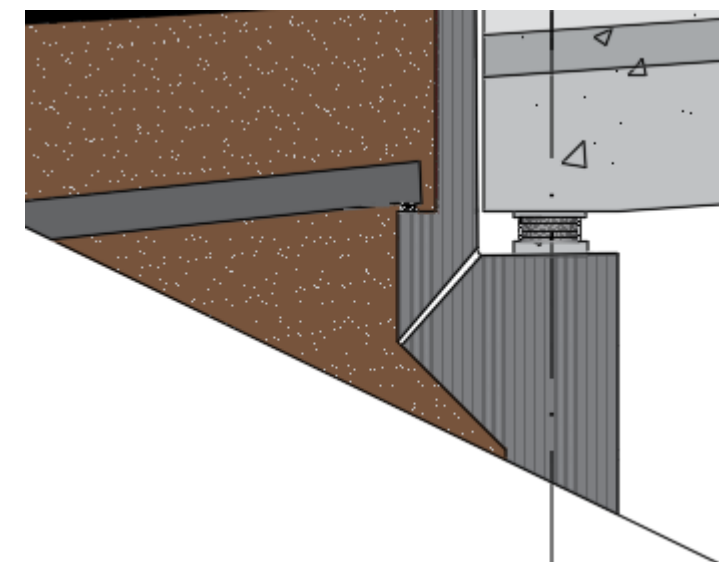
Detalle de la losa de transición en el estribo izquierdo.
